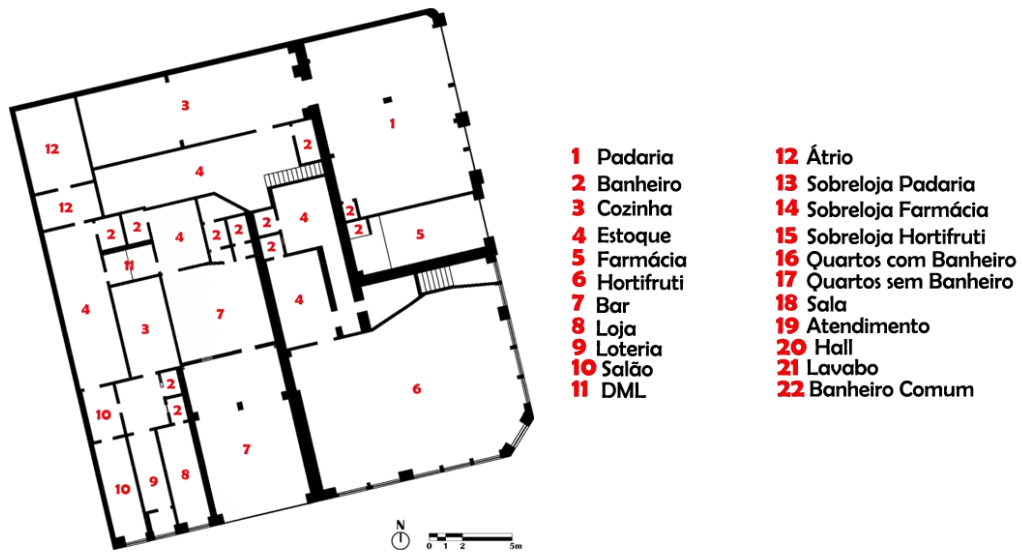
Ambientes pavimento térreo. Fonte: PERMEAR (2010) adaptado pela autora.
